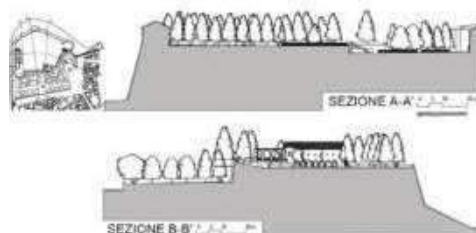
D. Falcioni, M. Mencarelli, Sezioni della Rocca di Camerino nello stato precedente al terremoto del 2016, 2021
